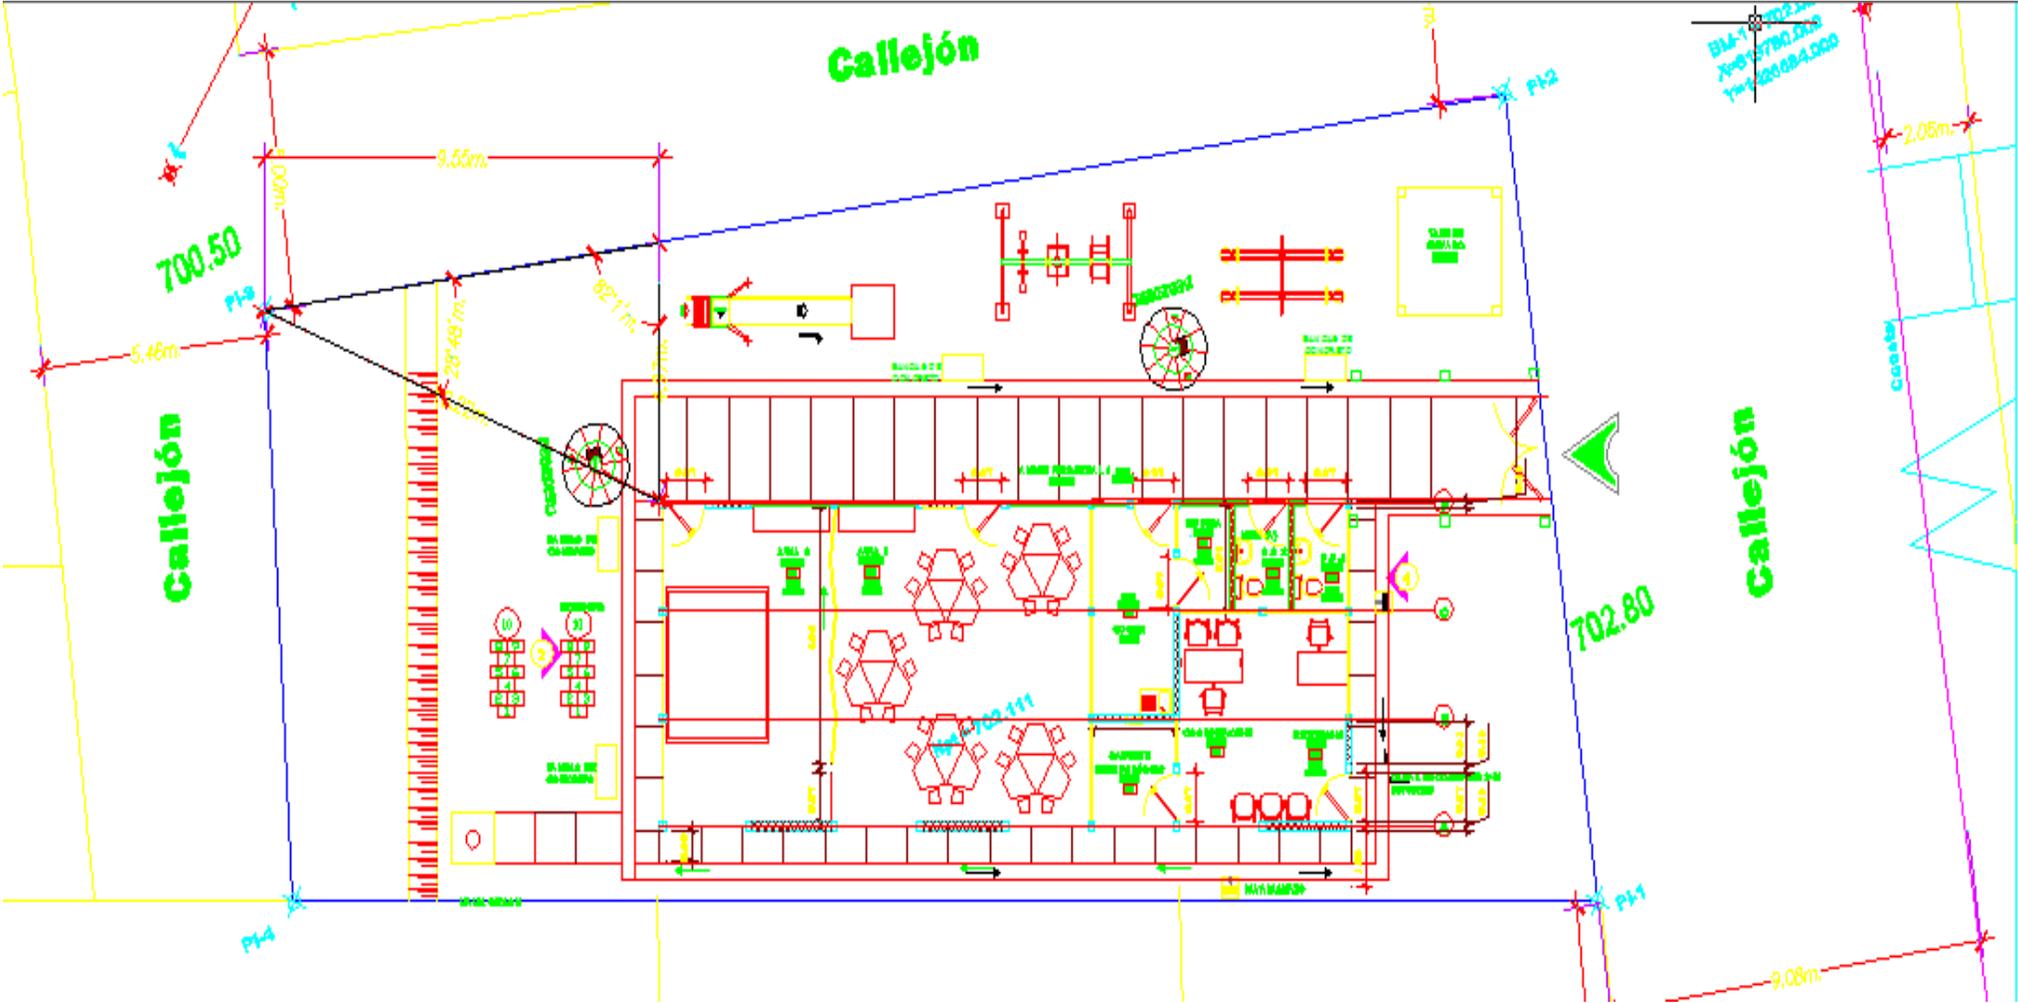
Plano de planta de conjunto y amarre proyecto CICO Bo. Solingalpa.
